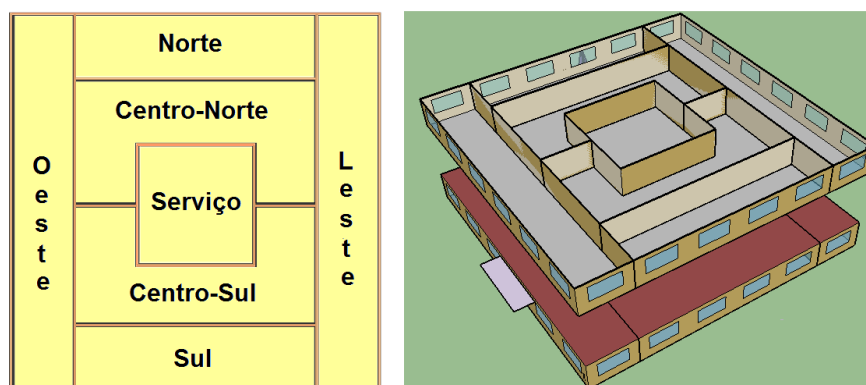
Configuração das zonas térmicas dos pavimentos
